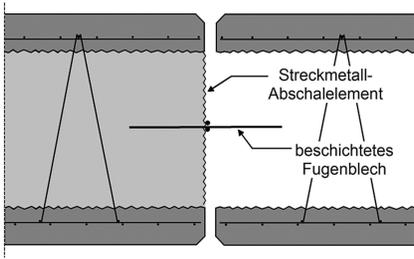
Streckmetallabschalung mit integriertem beschichtetem Fugenblech zur Herstellung einer vertikalen, »abgedichteten« Arbeitsfuge im Elementwandstoß
